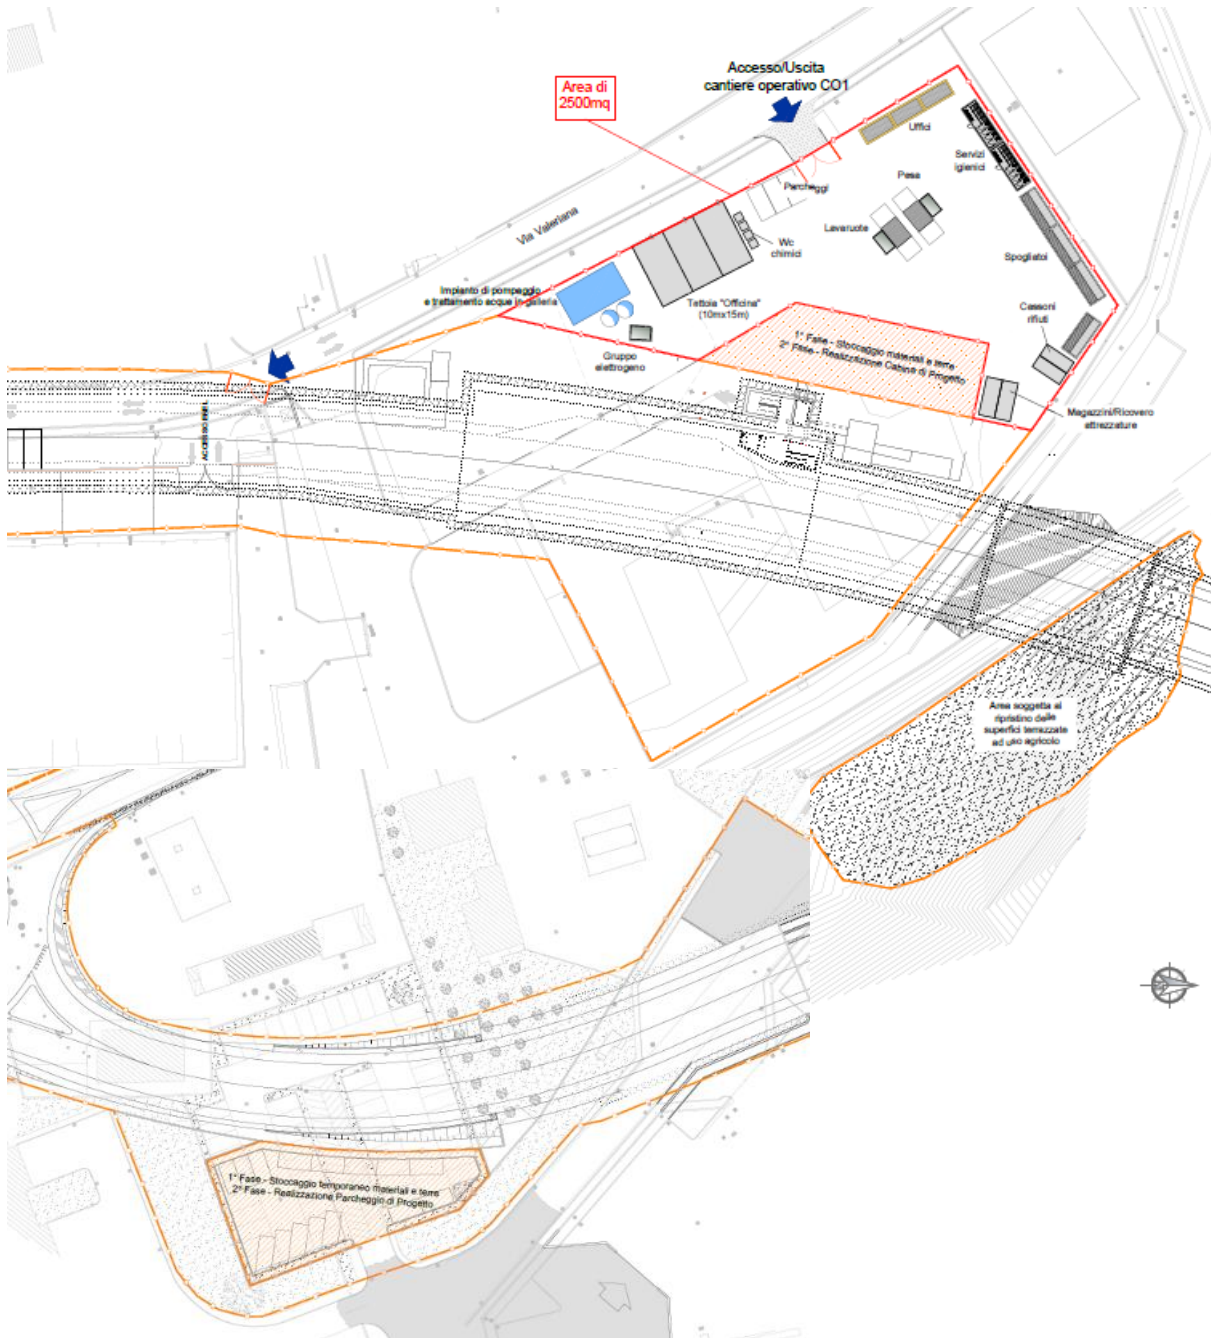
Layout del Cantiere Operativo Sud – inquadramenti di dettaglio (fonte: V02CA00CANSC01_B)
